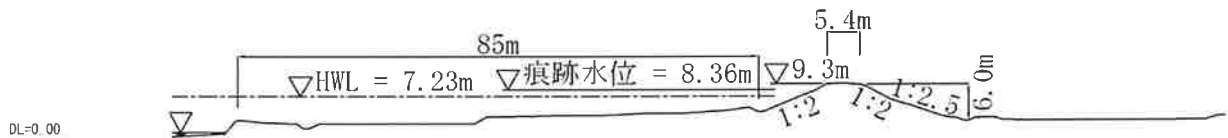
右岸 7.3k 付近堤防断面図 (①-①断面)
